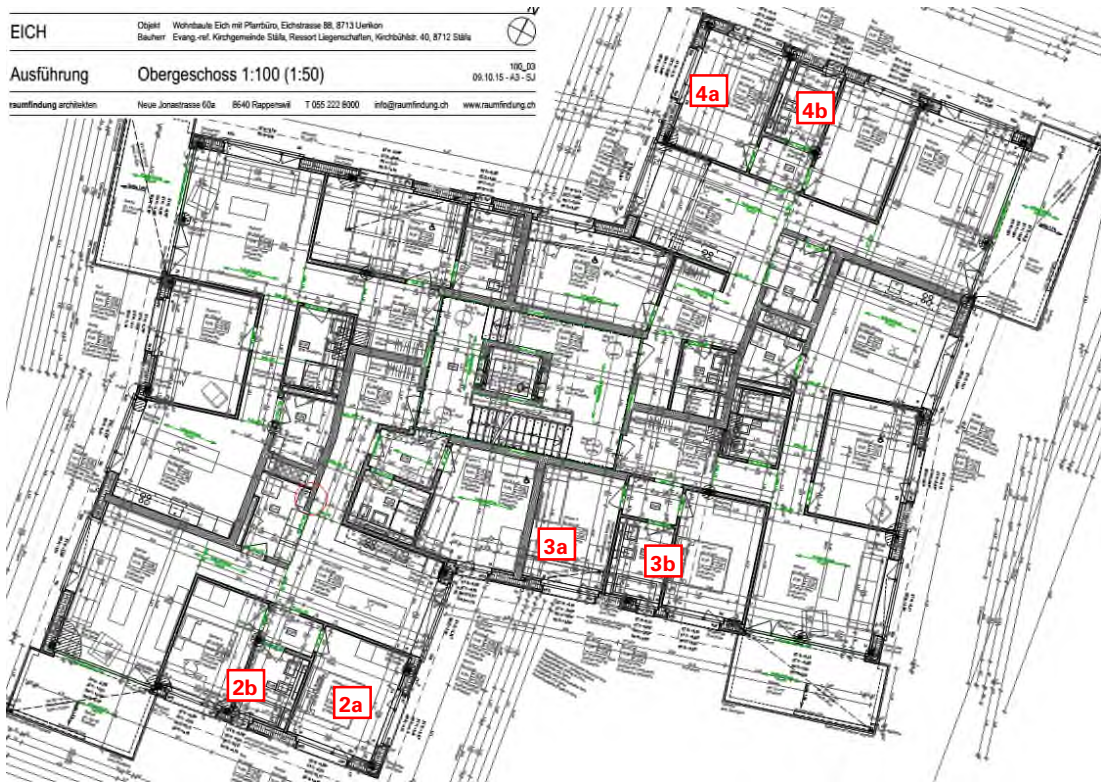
Grundriss OG mit Übersicht der Empfangsräume
